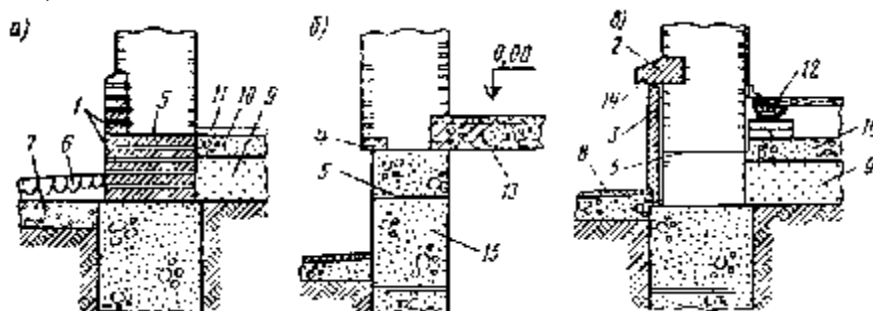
Цоколи кирпичных стен: а – облицованный кирпичом; б – цоколь без выступа в здании с подвалом; в – облицованный каменными плитами; 1 – клинкер; 2 – кордонный камень; 3 – каменные плиты; 4 – железобетонные бруски с сечением 75x120 мм; 5 – гидроизоляционный слой; 6 – булыжная отмостка; 7 – глина со щебнем; 8 – асфальтовый тротуар; 9 – щебеночная подготовка; 10 – бетонная подготовка; 11 – пол; 12 – пол деревянный на лагах по кирпичным столбикам; 13 – плита перекрытий над подвалом; 14 – осадочный зазор; 15 – бетонные фундаментные блоки.
